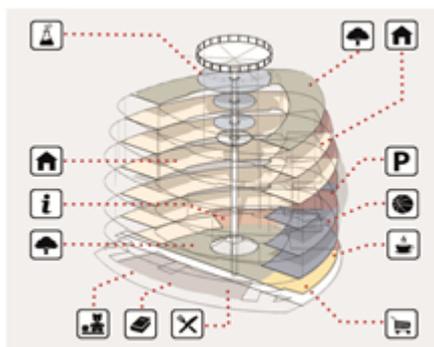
Схема функционального решения жилого здания на Крайнем Севере
